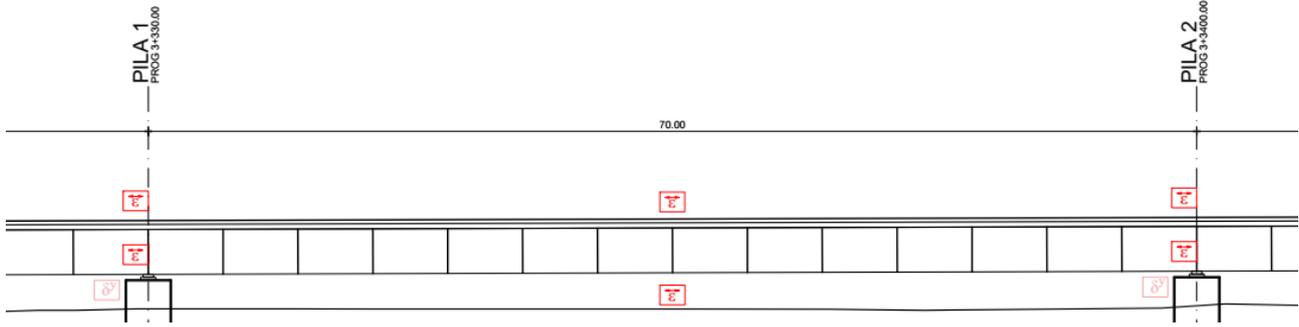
Ubicazione sensori su impalcato (sezione longitudinale campata tipo viadotto Tevere)
